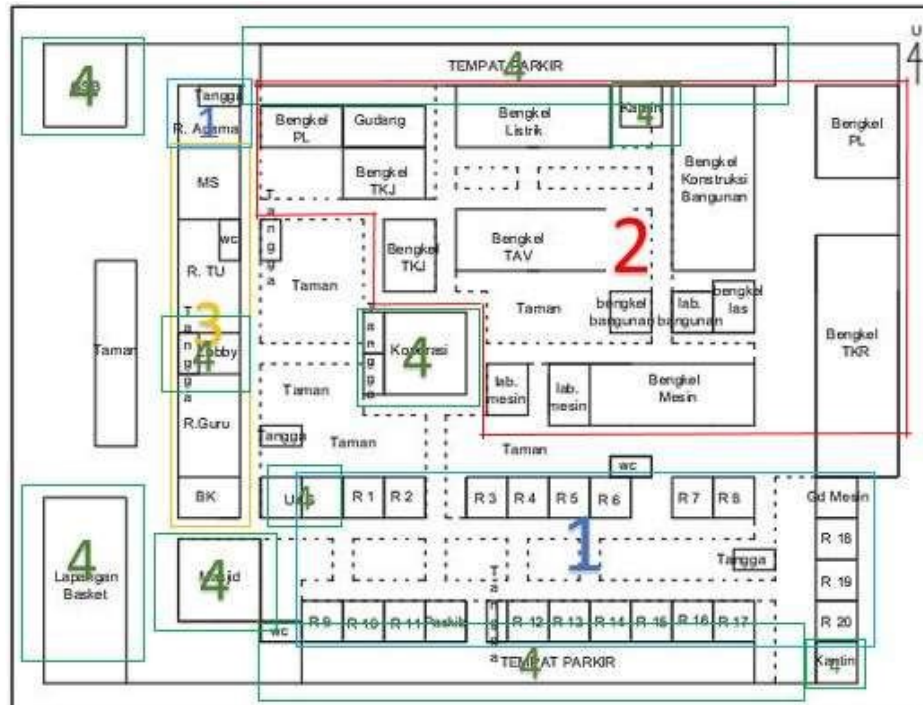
Denah Bangunan Lantai 1 di SMK Negeri 2 Klaten
